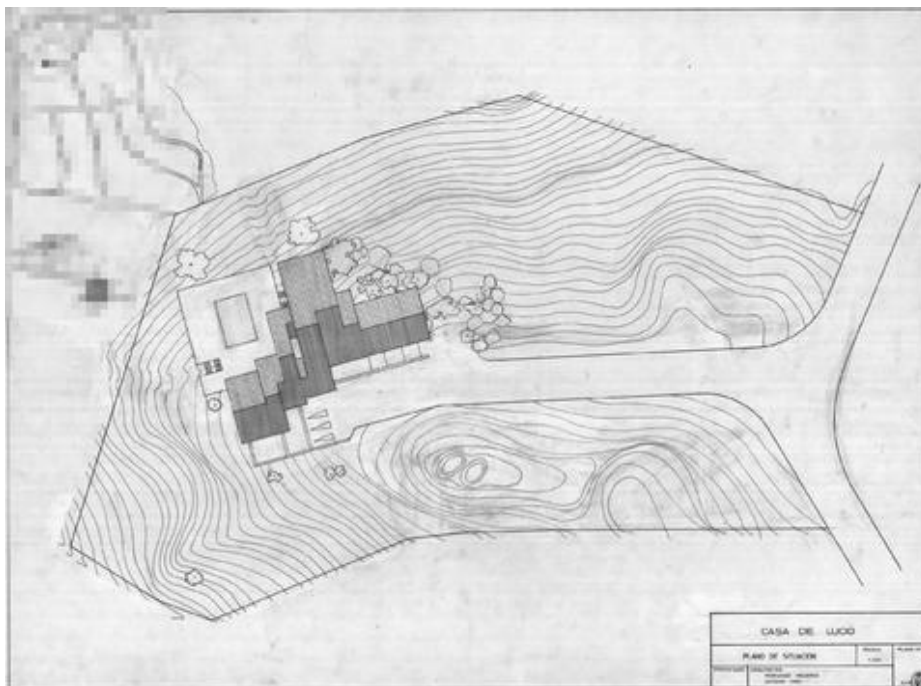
Plano de emplazamiento de la Casa Lucio Muñoz.
